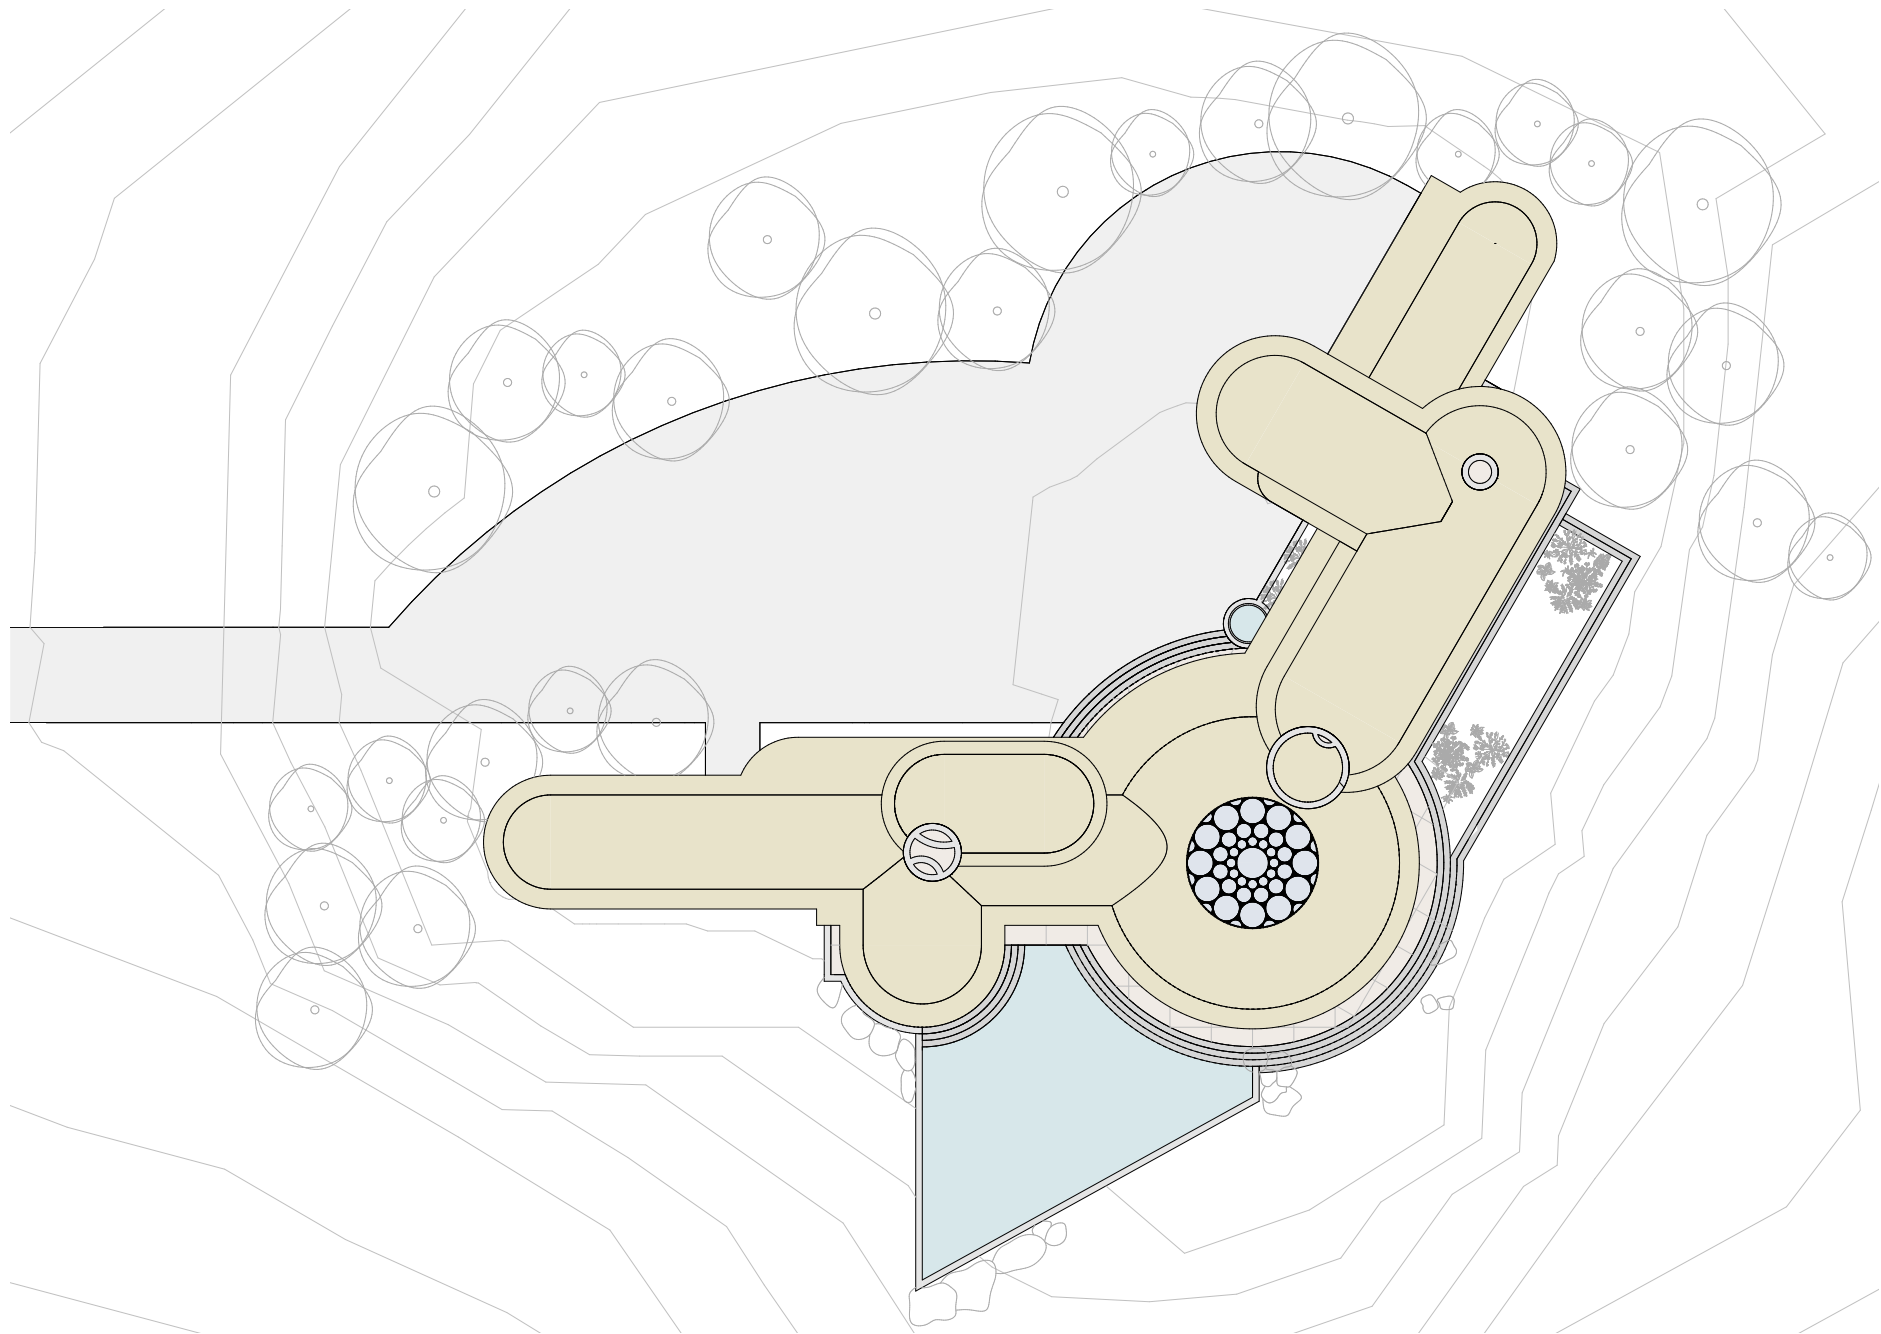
Casa Miller. Planta situación. Dibujada por la autora.
